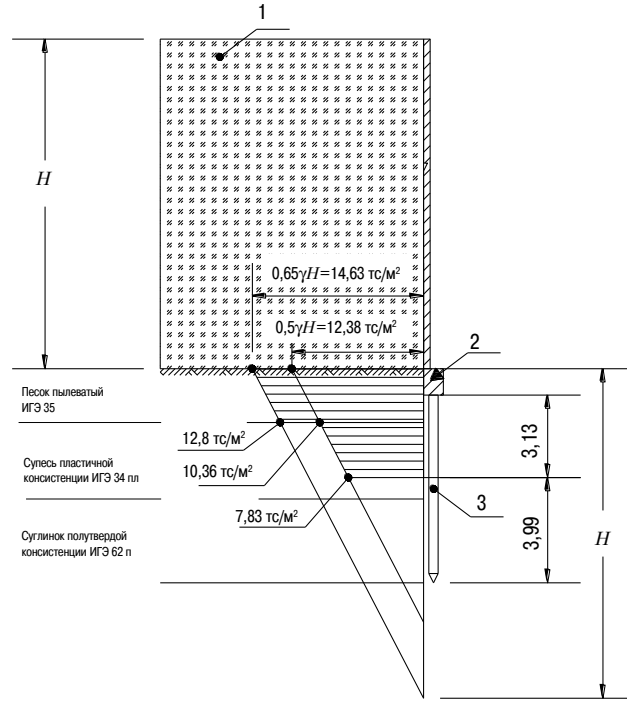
Эпюра распределения дополнительного горизонтального давления на сваи от веса подходной насыпи: 1 – армогрунт; 2 – ростверк фундамента открылка; 3 – забивные сваи 0,35х0,35 м
